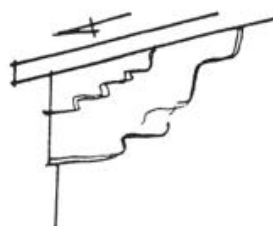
b : DILATACION FORJADO DE CUBIERTA
